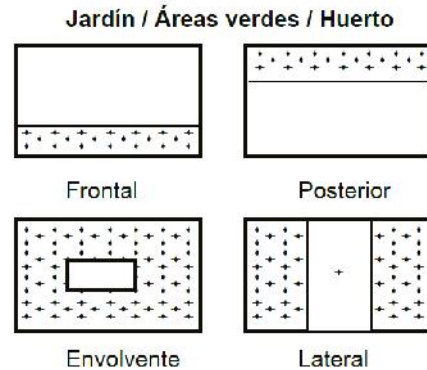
Tipología de escaleras áreas verdes y niveles
